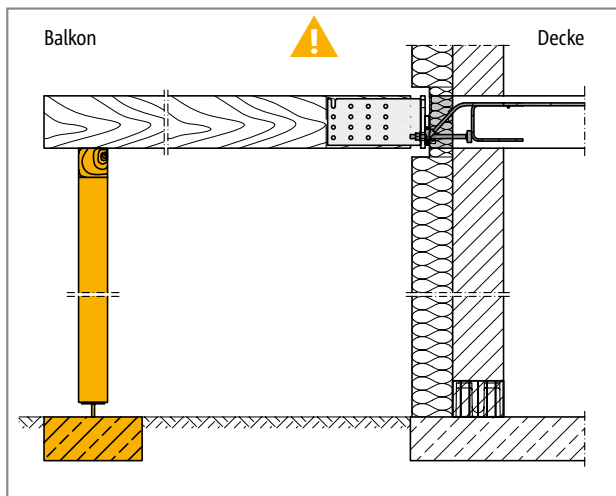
Schöck Isokorb® T Typ SQP mit Stahlschwert: Stützung durchgängig erforderlich
